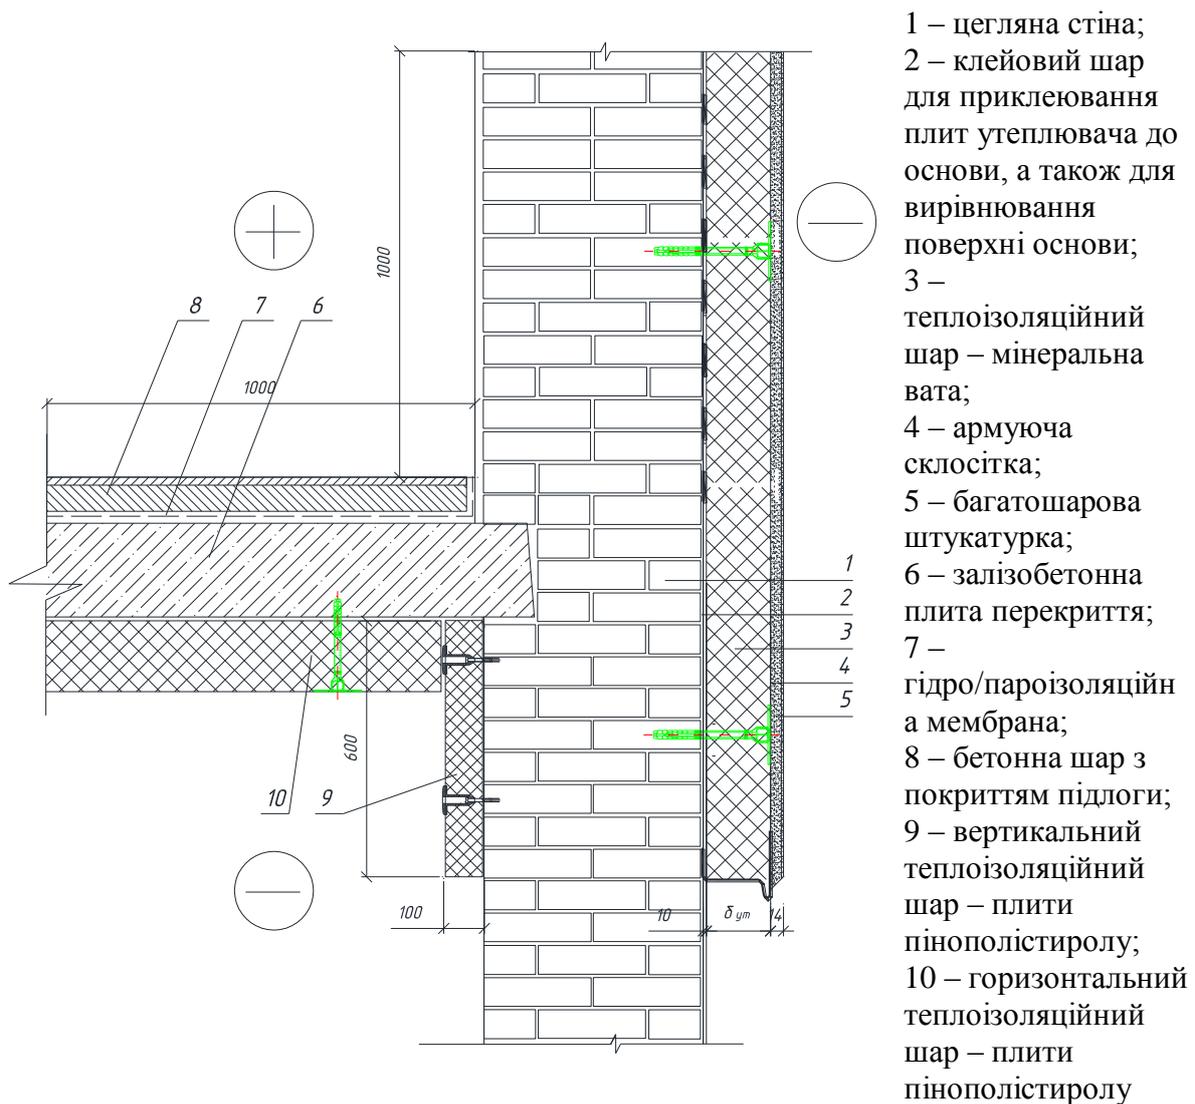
Схема утеплення перекриття над холодним підвалом з додатковим вертикальним утепленням
